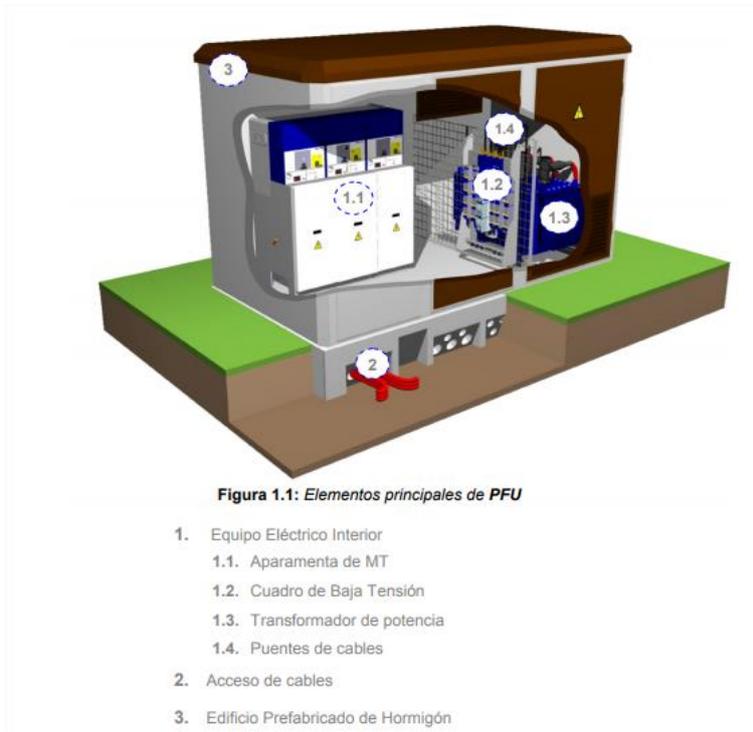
Centro de transformación prefabricado de hormigón con aparamenta típica.
